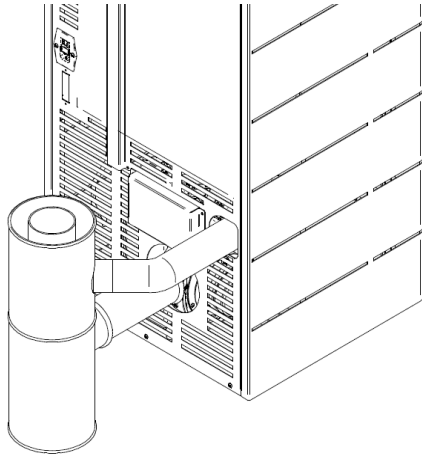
Encaixe T de inspeção coaxial com um aumento tramo horizontal
